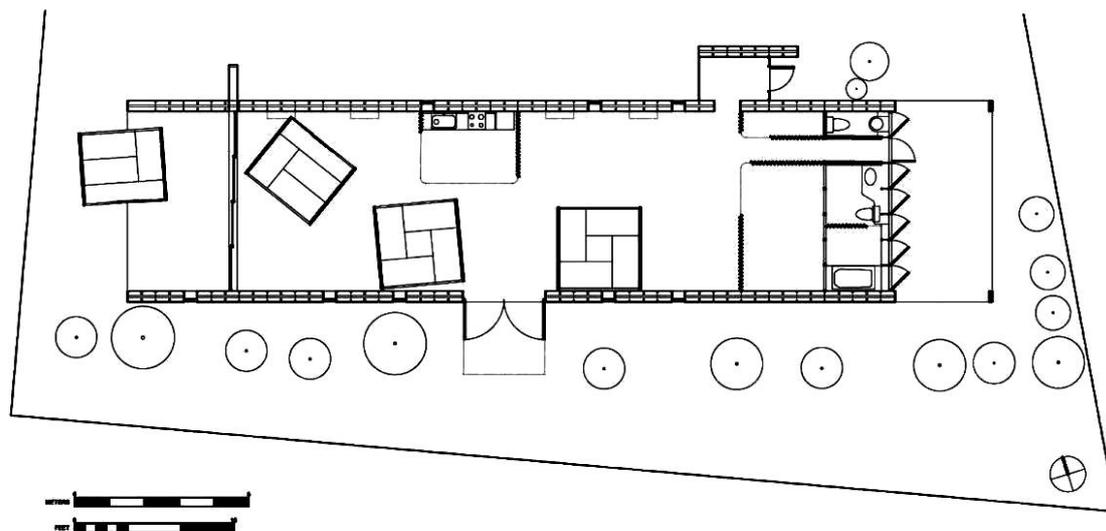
План этажа Обнаженного дома, арх. Шигеру Бан. Фото плана предоставлено: Shigeru Ban Architects [Источник: <https://archeyes.com/naked-house-shigeru-ban/>]
